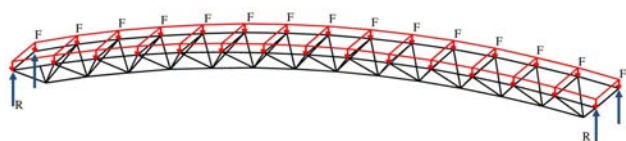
Розрахункова схема секції покриття прольотом 42 м з навантаженням F на плиту
